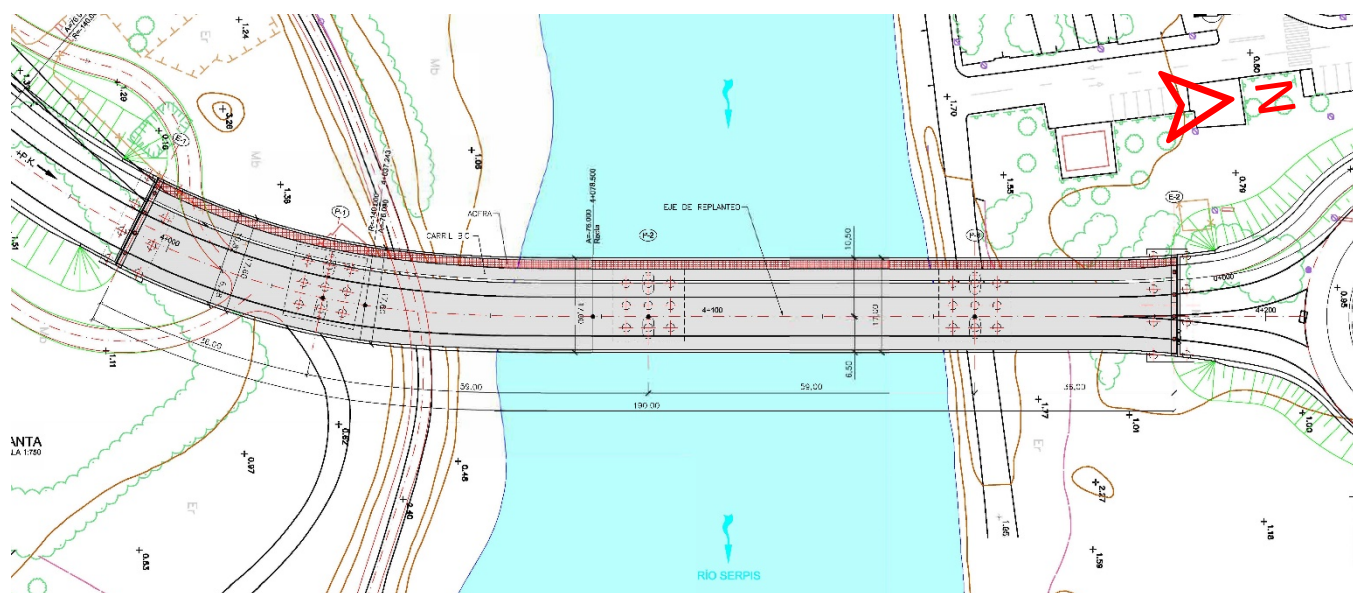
Plano en planta de la zona de actuación (Fuente: Proyecto Acceso Sur al Puerto de Gandía).
